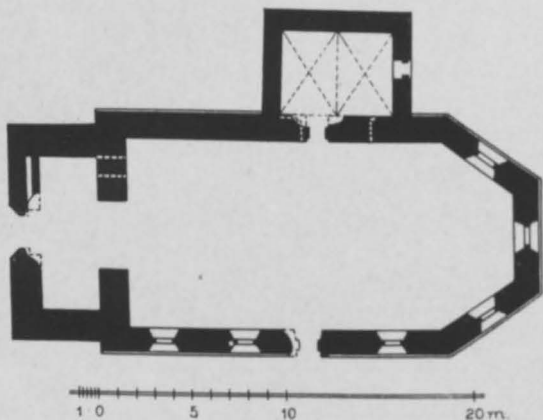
Fürstlich Drehna. Wüste Kirche, Grundriß.
